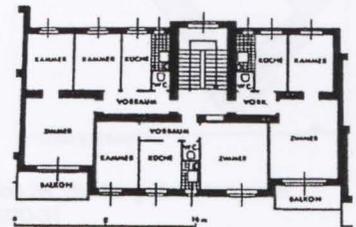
Dreispanner-Grundriss eines städtischen Wohnhauses nach 1923 mit Vorraum, Bad, WC, und 2-3 Zimmern !
